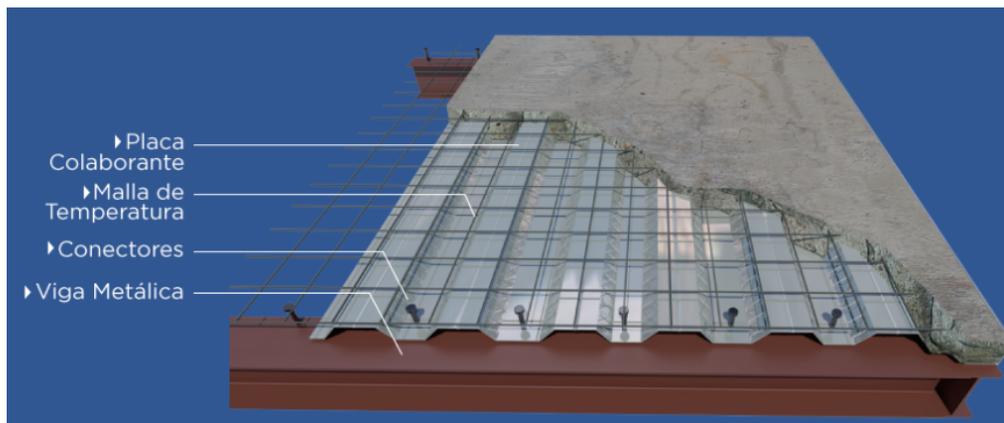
Elementos del sistema losa colaborante con estructuras metálicas.
